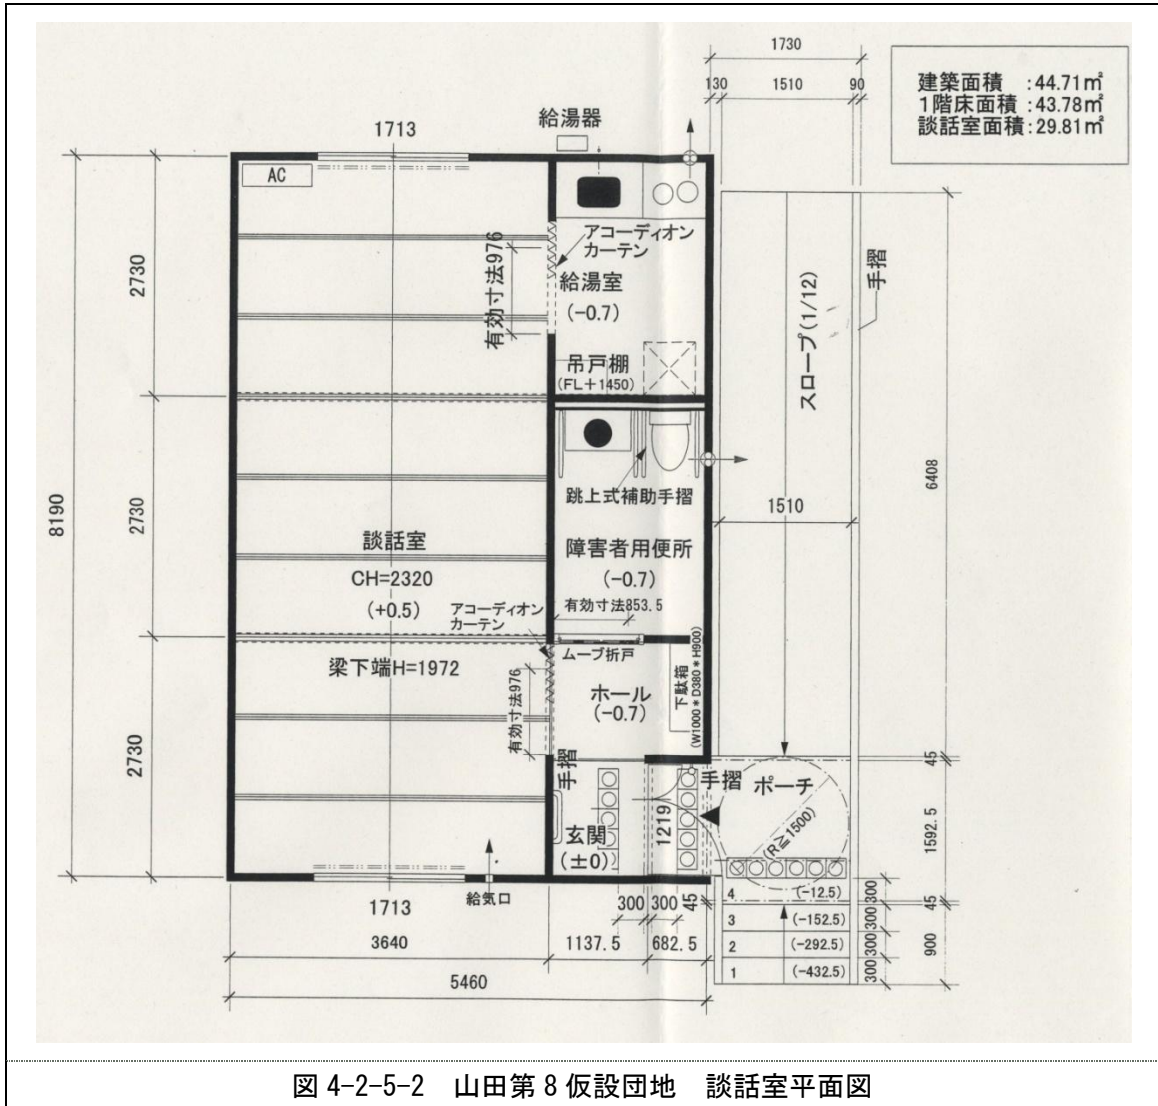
山田第 8 仮設団地 談話室平面図
